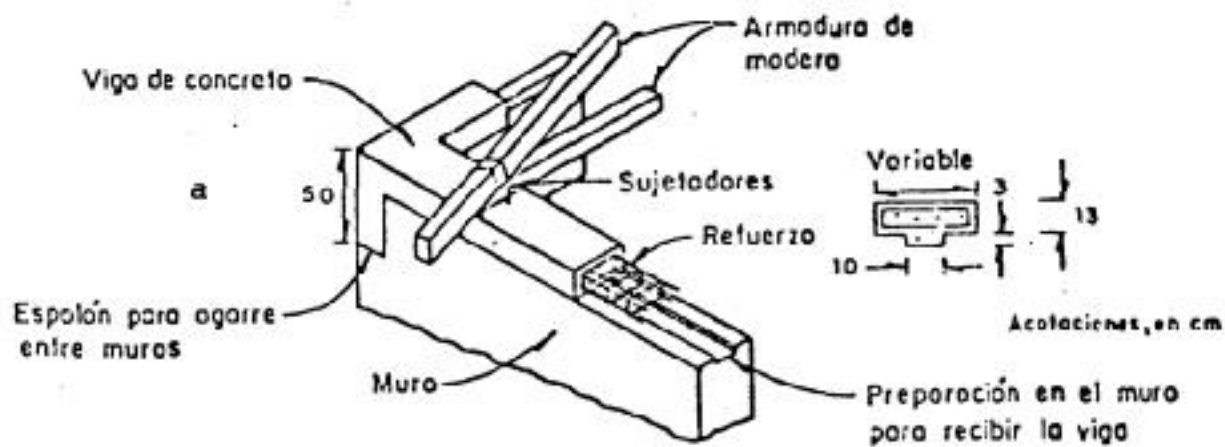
Confinamiento de muros de mampostería con cadena perimetral (refs. 9 y 10)
